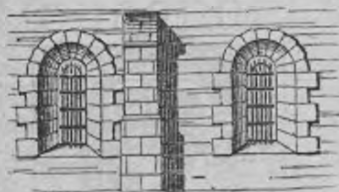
Croisées du rez-de-chaussée au *xi^e* siècle.
